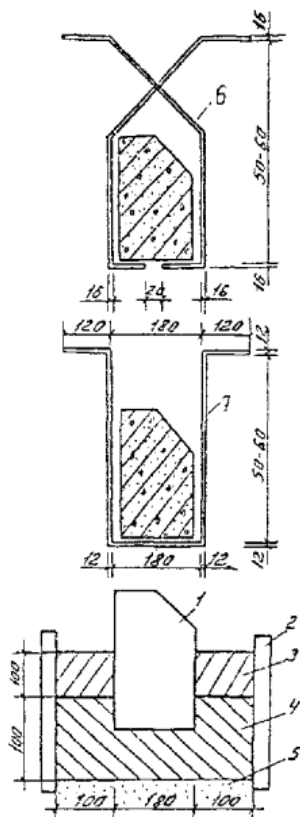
Схемы приспособлений и оснастки для установки бортовых камней:
